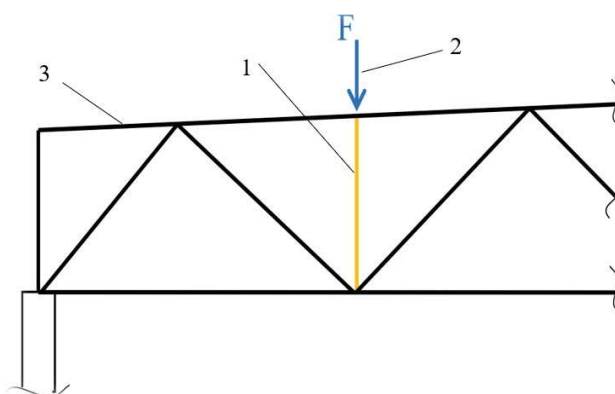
усиление сжатых верхних поясов: 1 — дополнительные раскосы, 2 — внеузловая нагрузка, 3 — усиливаемая ферма
